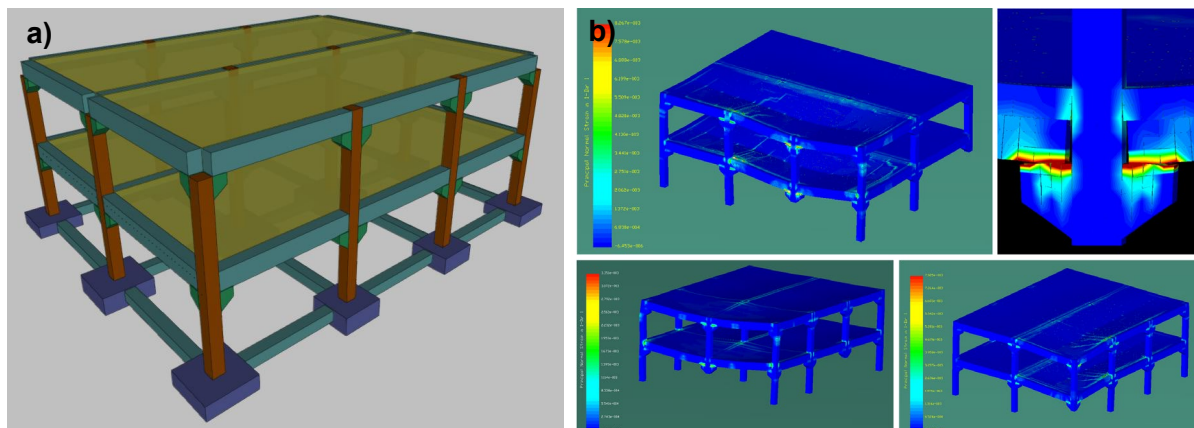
Diseño del edificio con estructura prefabricada de hormigón (a) y resultados preliminares (b).
